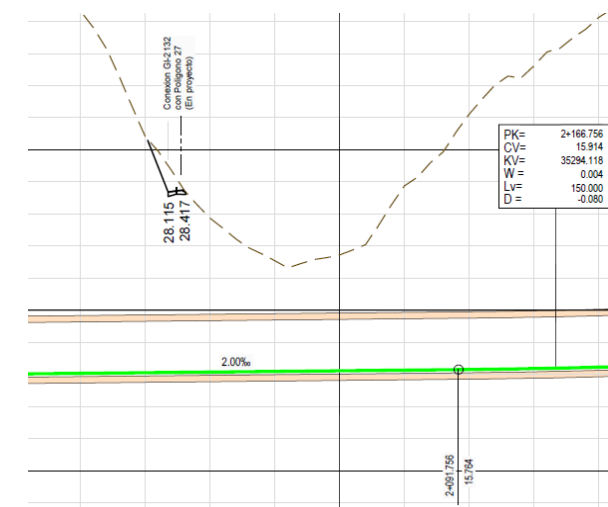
Zona de baja cobertera entre los PP.KK. 1+912 – 2+027.
